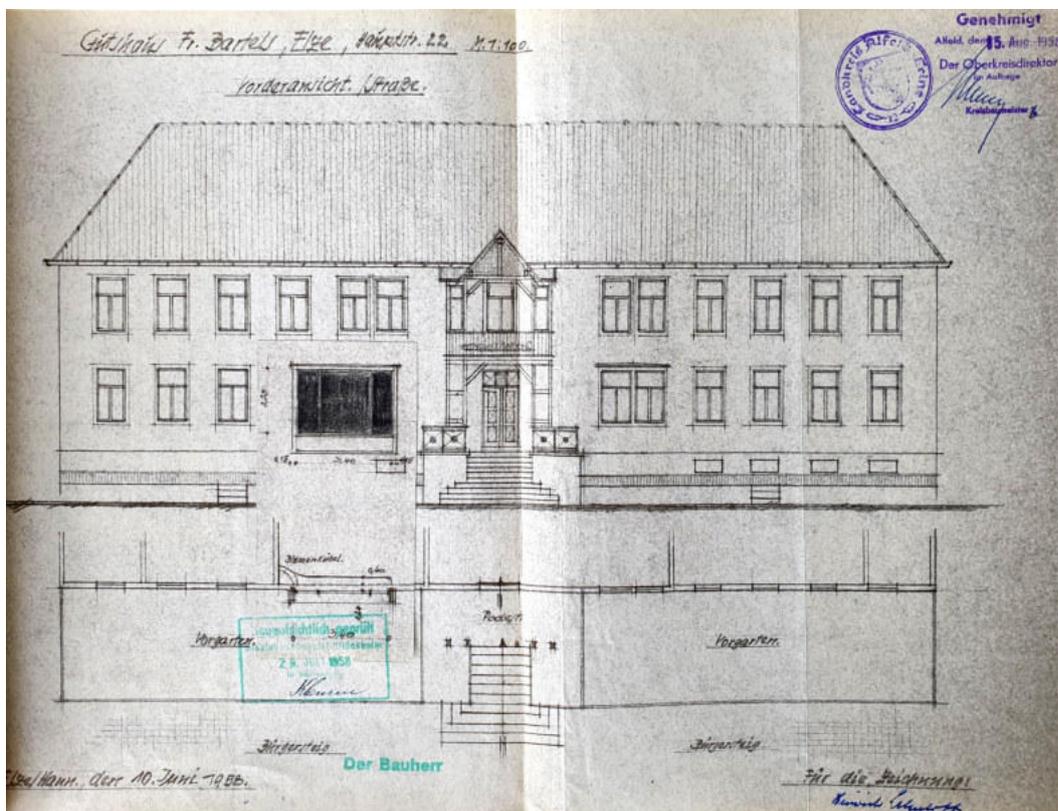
Planzeichnung (Fassade, Teilgrundriss) für den Einbau des Panoramafensters (1958).
